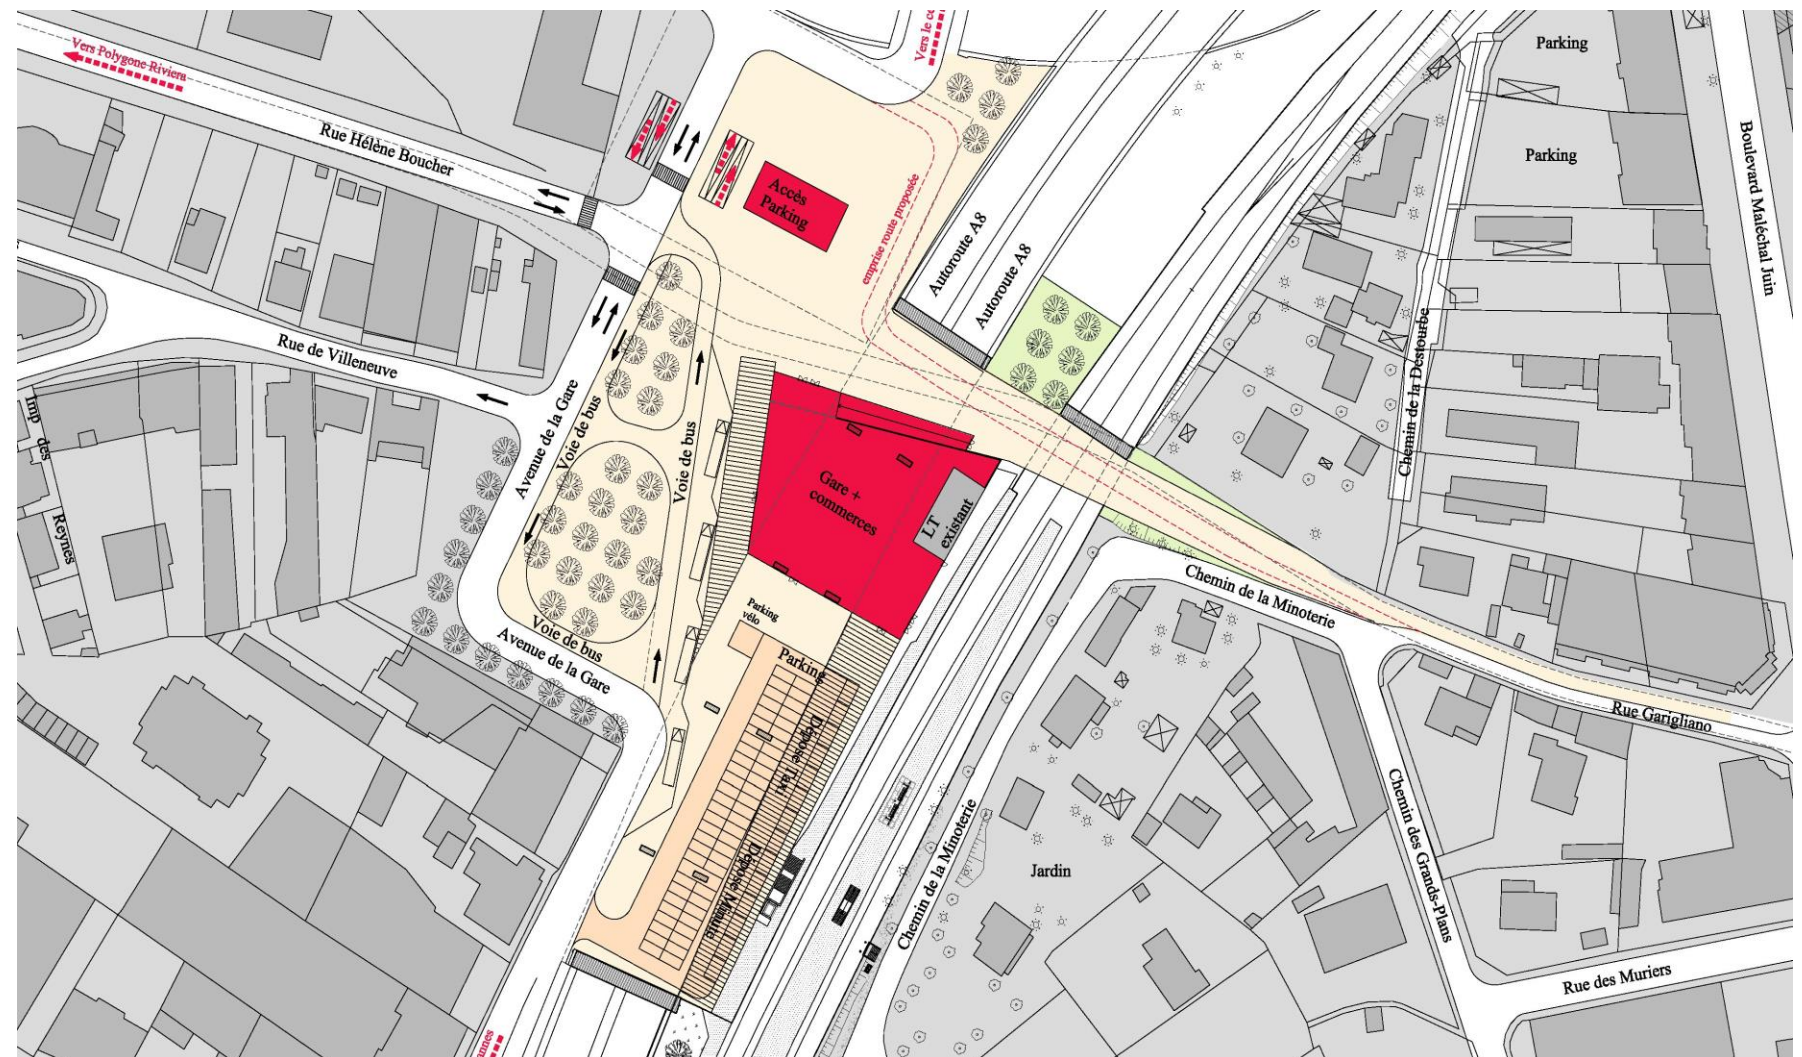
Variante 3 - plan (AREP-sans échelle)
